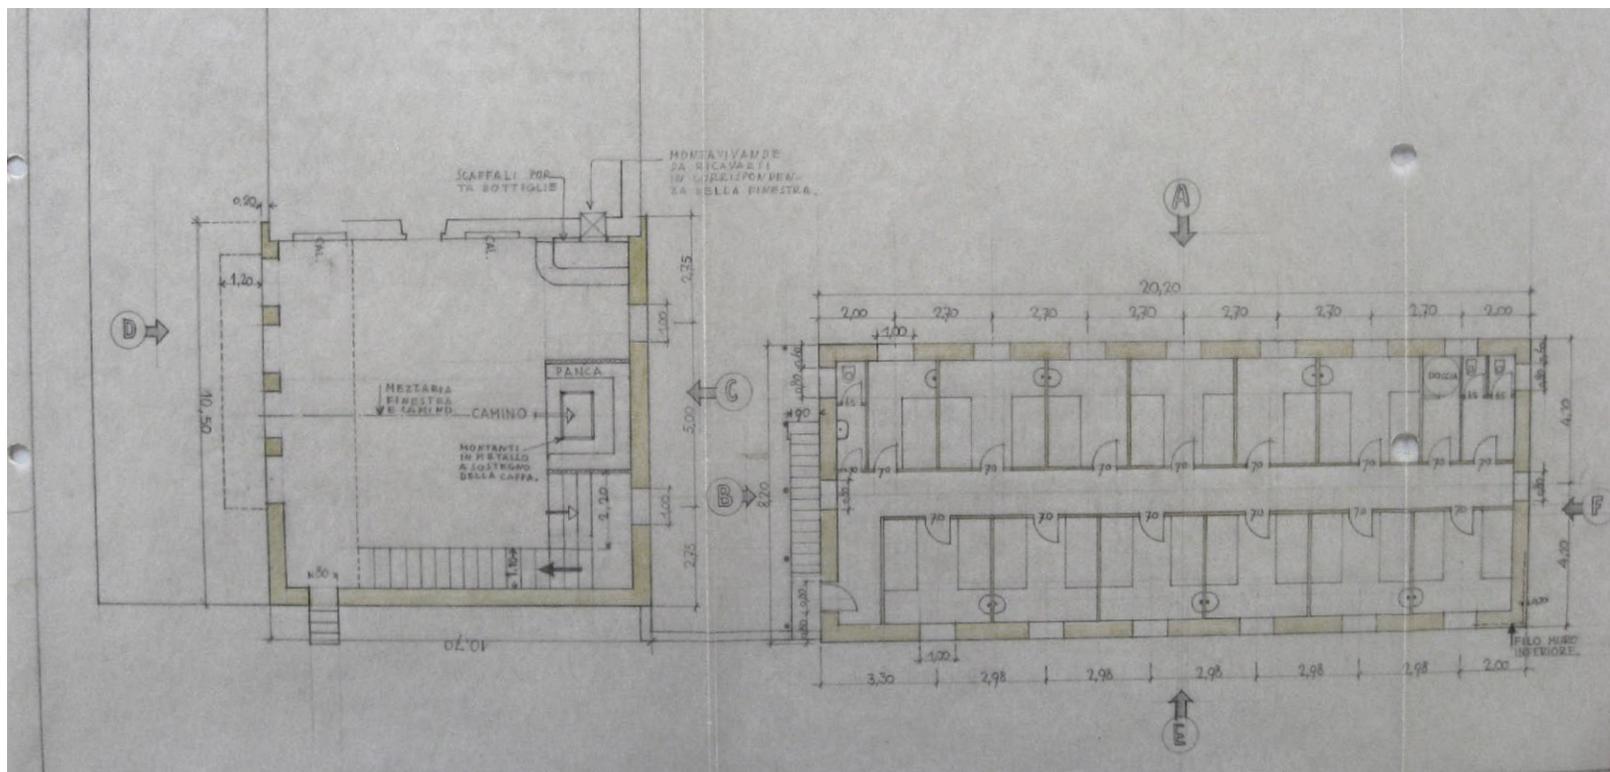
Grundriss 1.OG: ein Aufenthaltsraum mit Kamin und weitere 12 Zimmer
